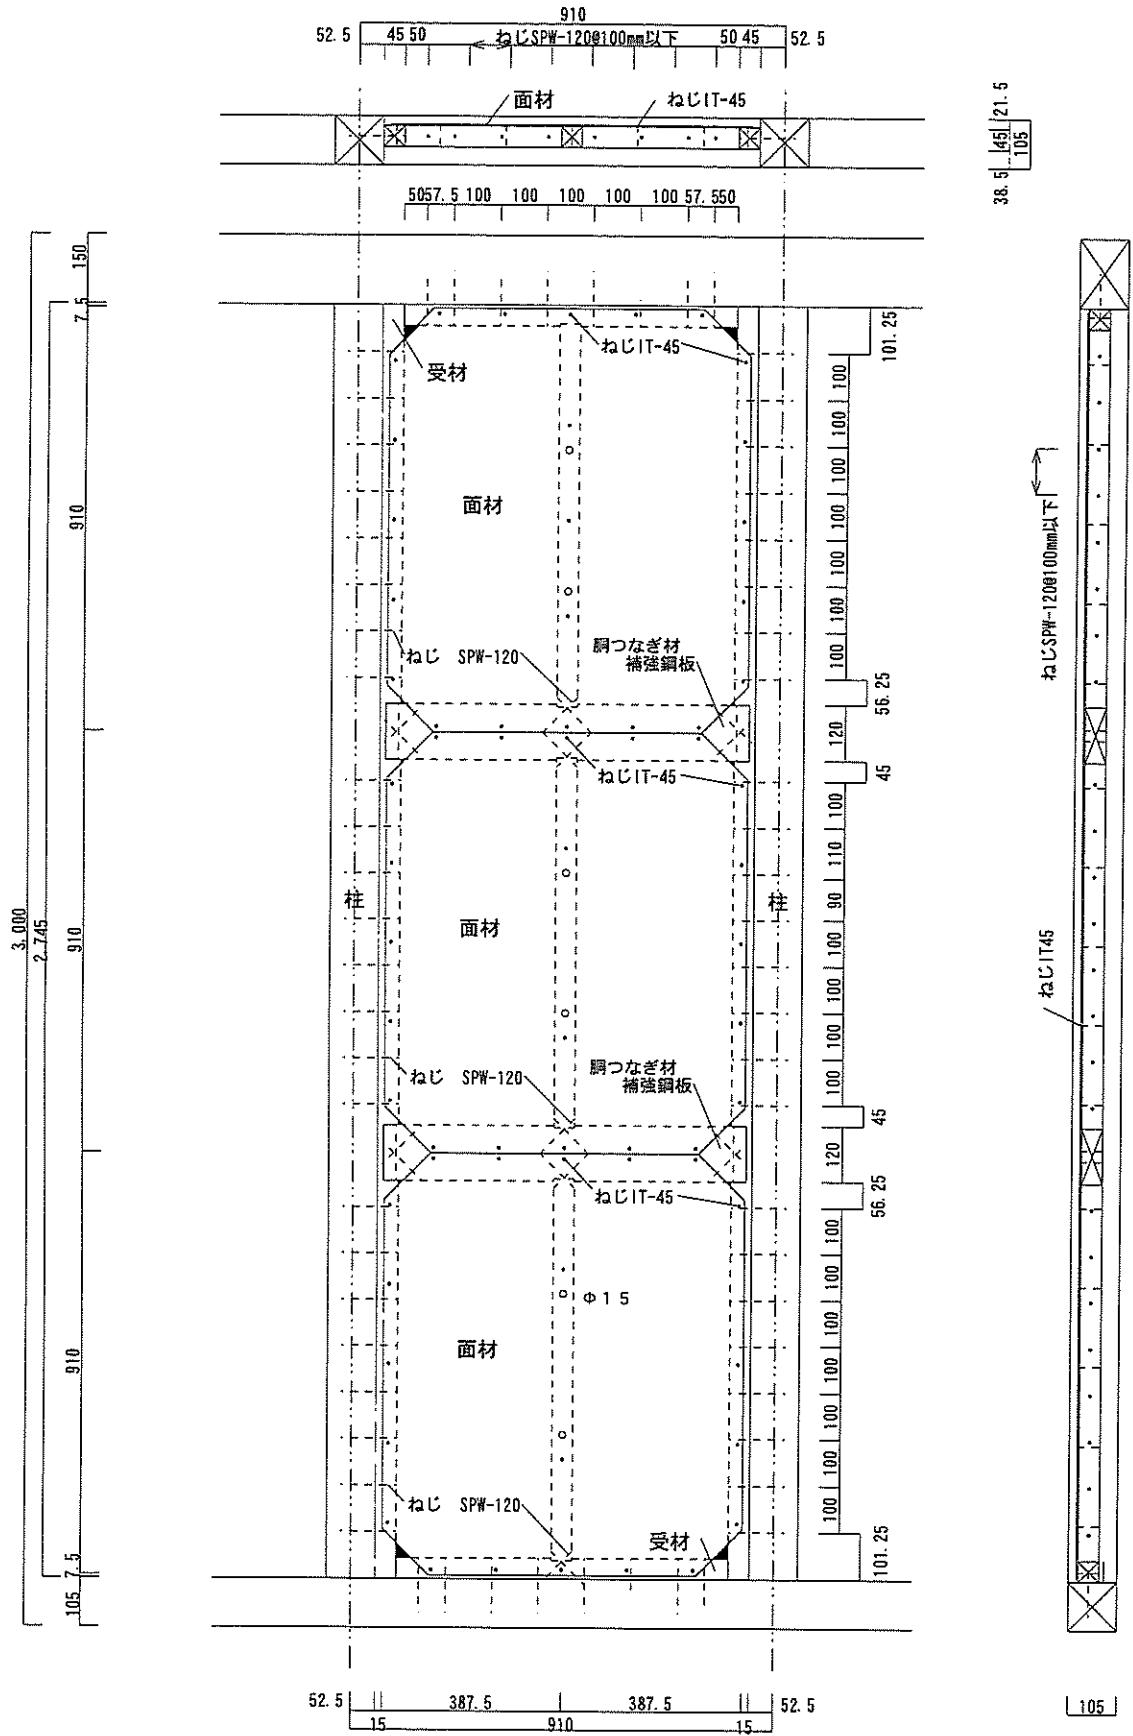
施工図 (柱寸法: 105×105mm、壁高さ最小時) (寸法単位: mm)
